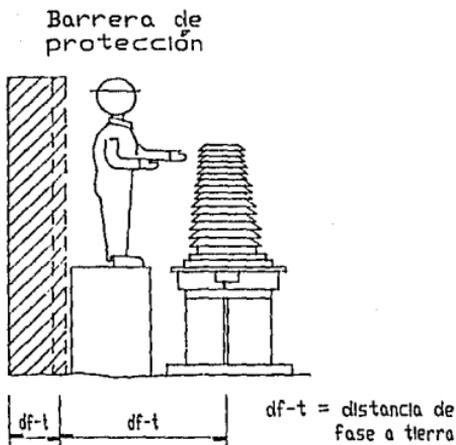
AISLAMIENTO CON BARRERA DE PROTECCION
